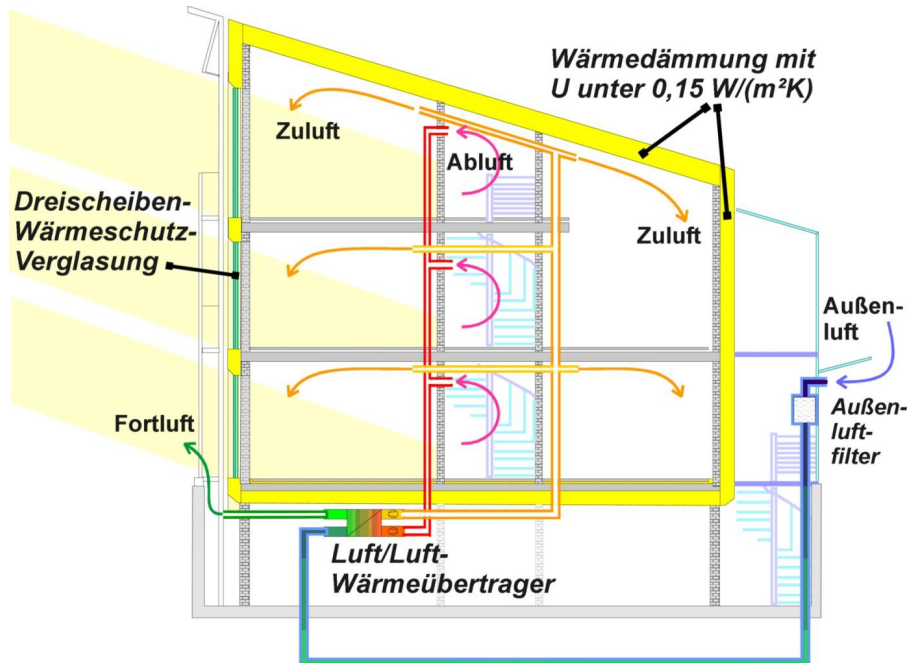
Schnitt durch das Passivhaus Darmstadt Kranichstein mit den wichtigsten Elementen energieeffizienter Gebäude im kühl-gemäßigten Klima: Rundum sehr gute Wärmedämmung, Dreischeiben-Wärmeschutzverglasung und Wärmerückgewinnung (Detailangaben vgl. Tabelle 1)
